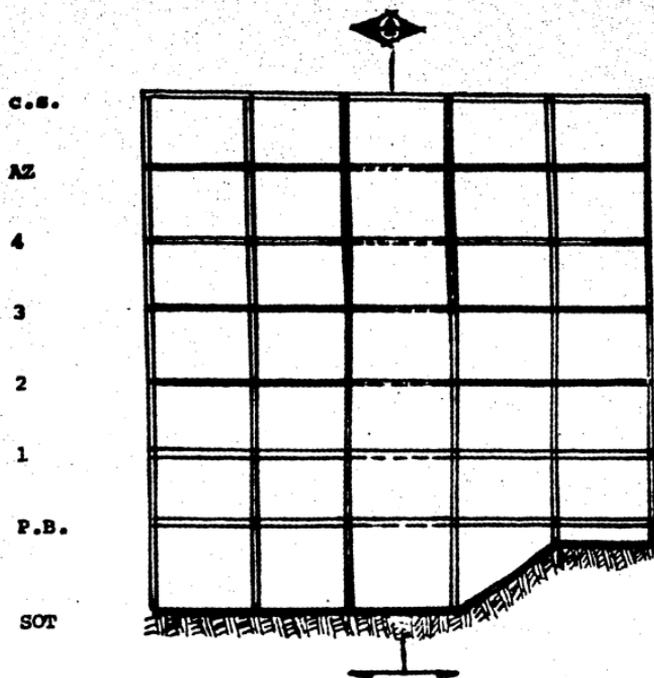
Corte longitudinal donde se muestra la elevación esquemática de niveles, aquí se muestra el criterio de análisis sísmico, como se puede ver el edificio, se analiza como si fuera dos - enteramente independientes. (Las líneas punteadas muestran - la junta constructiva que desliga estructuralmente los cuer - pos simétricos del inmueble, permitiendo así el libre movimien - to de ambos, ocasionando un análisis sísmico convencional por separado.)
